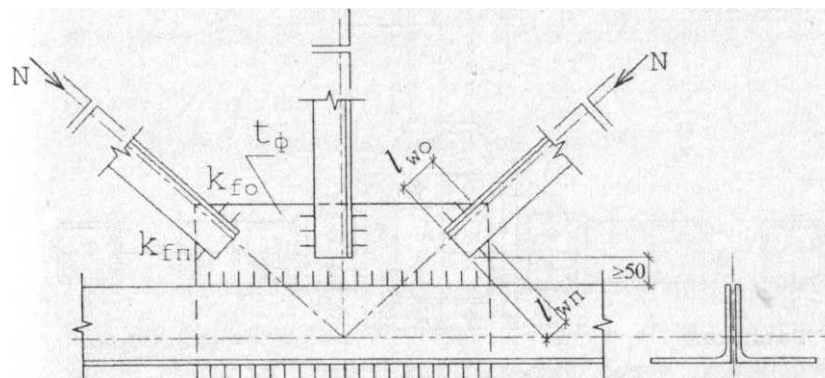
К расчету узла нижнего пояса фермы из парных уголков
